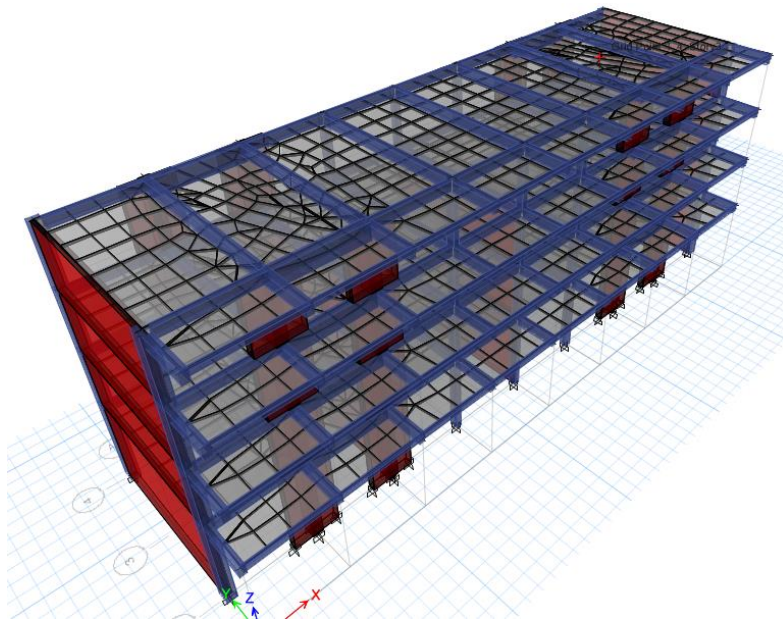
Vista general del modelo estructural del módulo de Edificación Projectada (EP) en 3D
